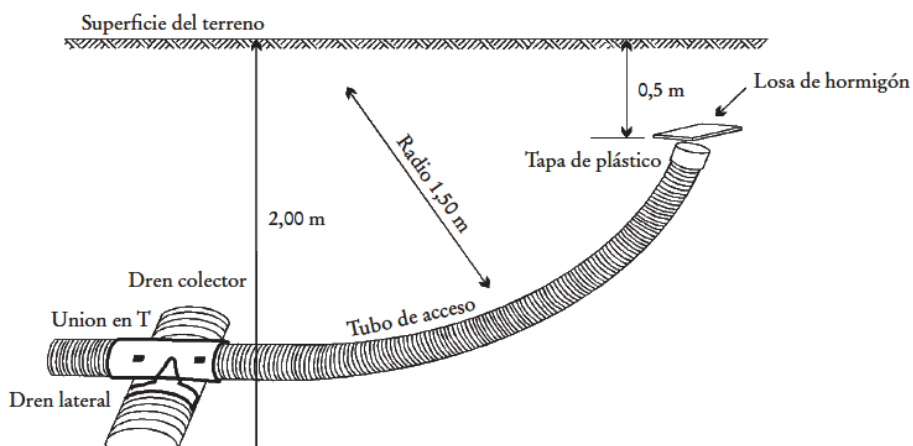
Facilitador de limpieza (Fuente FAO)
